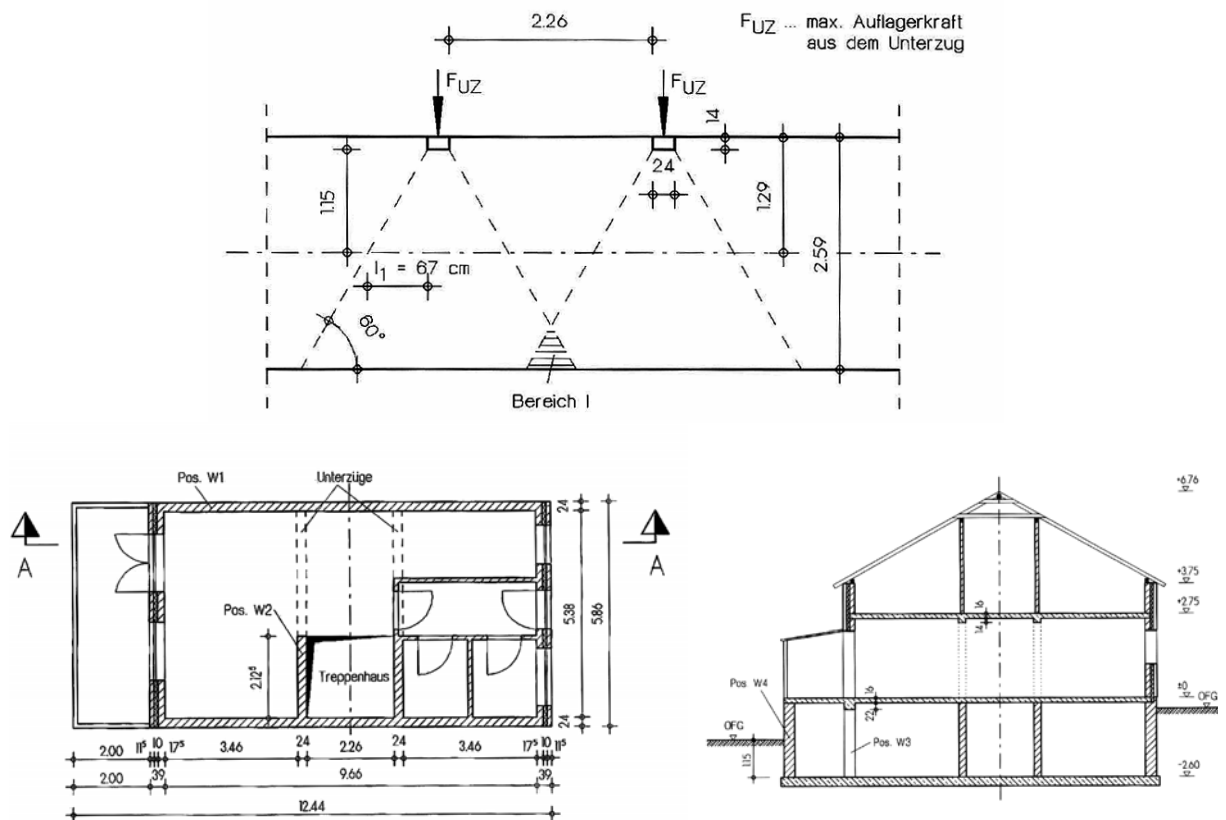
Gewählte Bemessungssituation für ein Einfamilienreihenhaus nach /Hof07/; Darstellung der Belastungssituation für die Wand Pos. W1 (oben); Grundriss des Erdgeschosses (links unten) und Schnitt durch alle Etagen (rechts unten)
